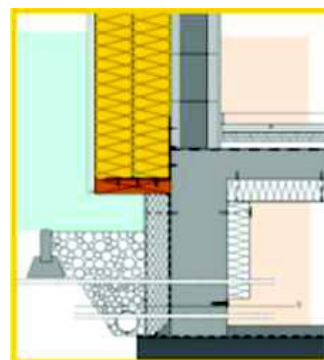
Detaliu perete exterior (parter) [82]
